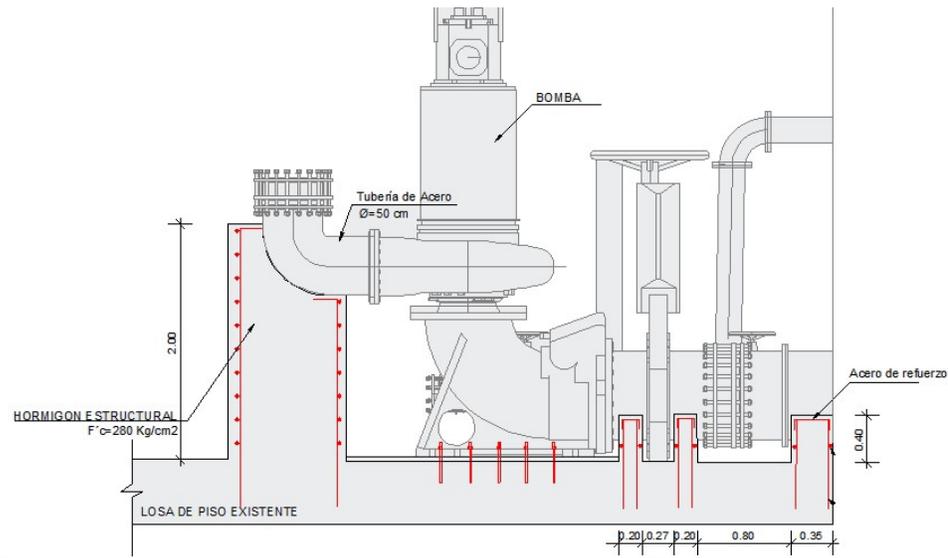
Sistema de Anclaje de Hormigón Armado en Bombas y Válvulas.
